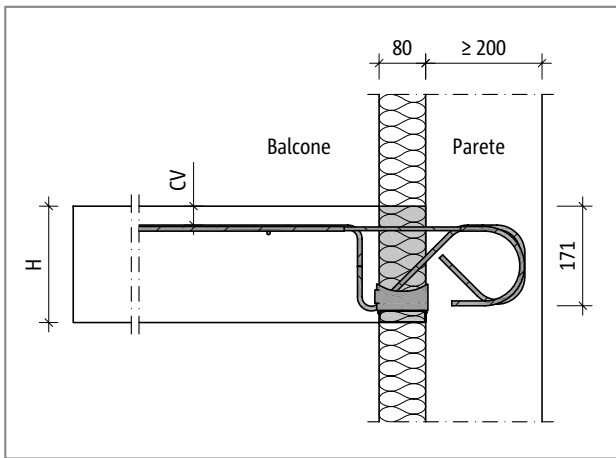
Schöck Isokorb® tipo K10S-UZ – K60S-UZ: raccordo alla parete con isolamento esterno
